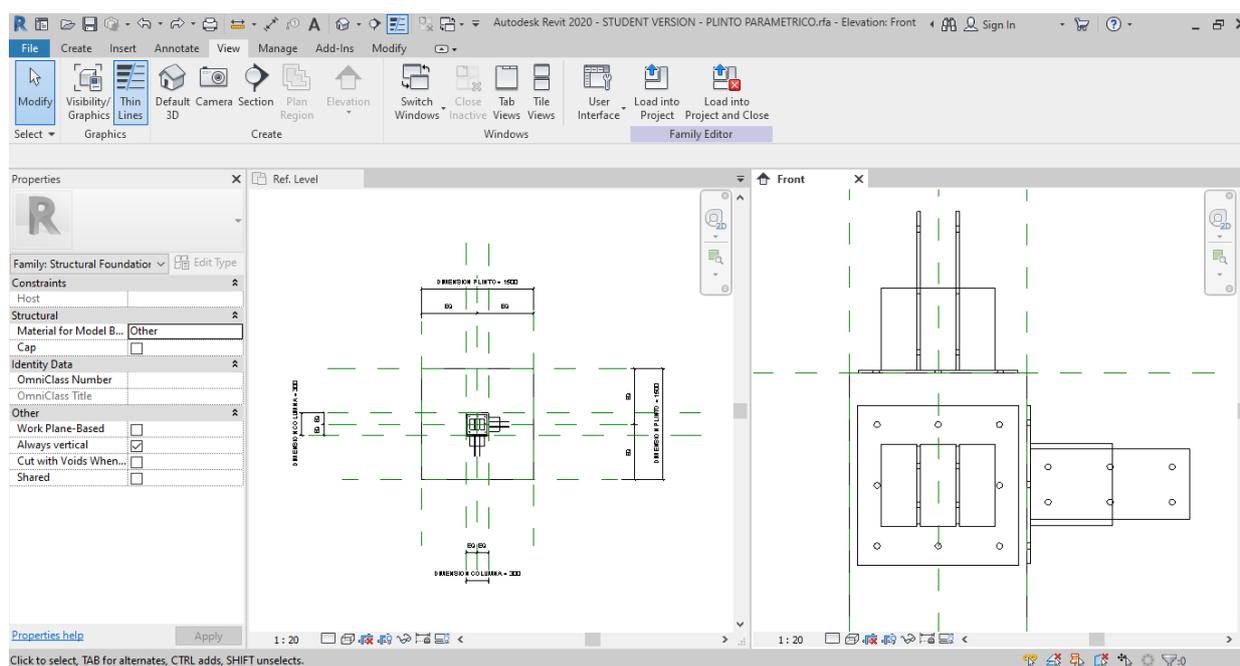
Prototipo 2: Conexión Estructural Hormigón – Acero – Madera.
